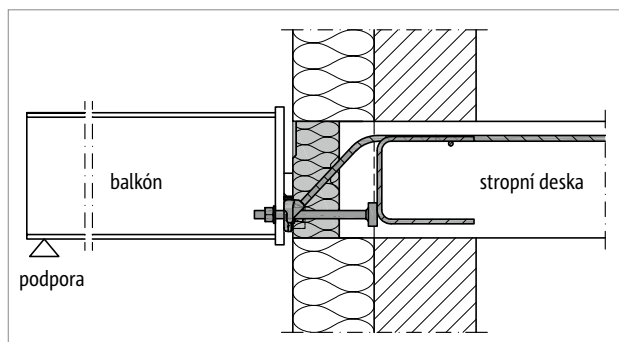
Schöck Isokorb® T typ SQP-WU: Atypické provedení; nutné u napojení na železobetonovou stěnu
